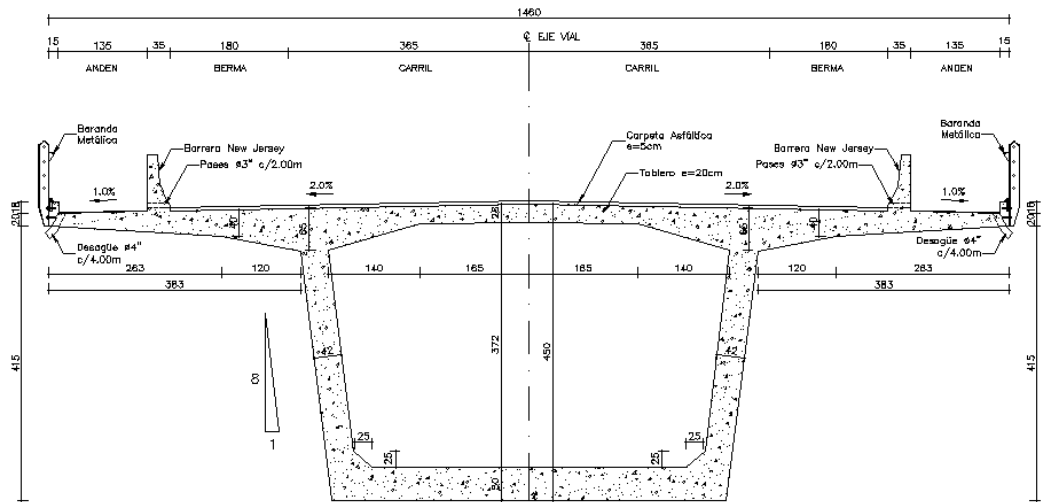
Sección transversal puente San Pedro – Zona voladizos
